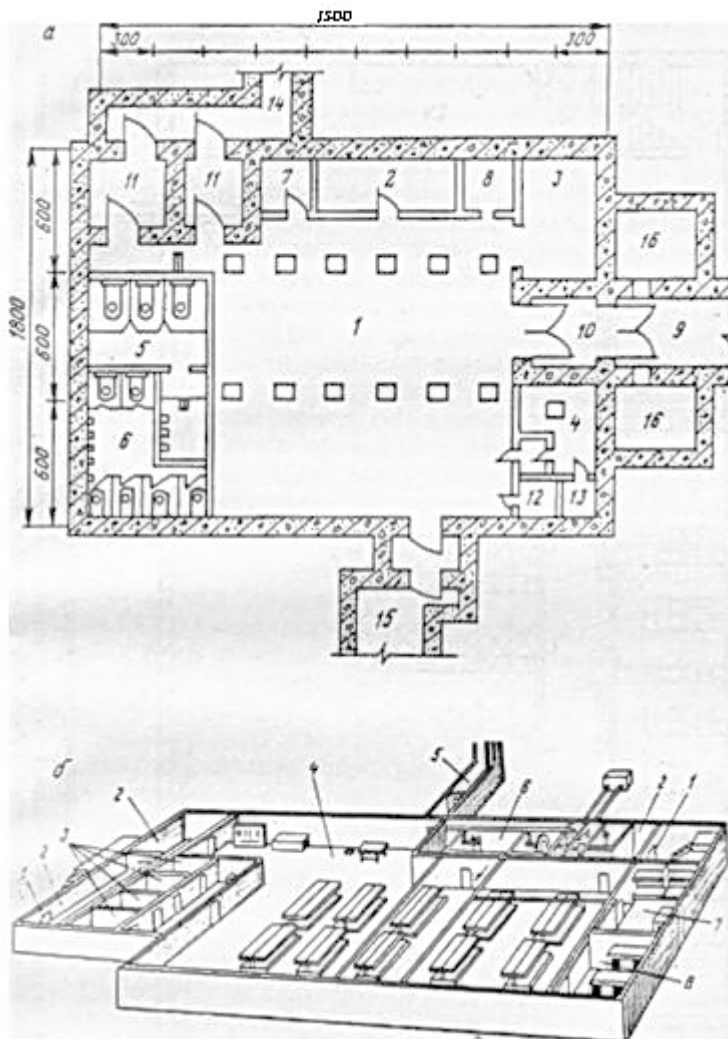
Убежище: *а* – планировка (1,2 – помещения для людей; 3 – фильтровентиляционная камера; 4,8 – складские помещения; 5 – женский санузел; 6 – мужской санузел; 7 – кладовая; 9 – наклонная рампа; 10 – шлюз наклонной рампы; 11 – тамбуры; 12 – щитовая; 13 – склад горюче-смазочных материалов; 14 – вход 1; 15 – вход 2, или аварийный выход; 16 – расширительные камеры); *б* – вид сверху (1 – защитно-герметические двери; 2 – шлюзовые камеры; 3 – санитарно-бытовые отсеки; 4 – основное помещение для размещения людей; 5 – галерея и оголовки аварийного выхода; 6 – фильтровентиляционная камера; 7 – кладовая для продуктов питания; 8 – медицинская комната)
